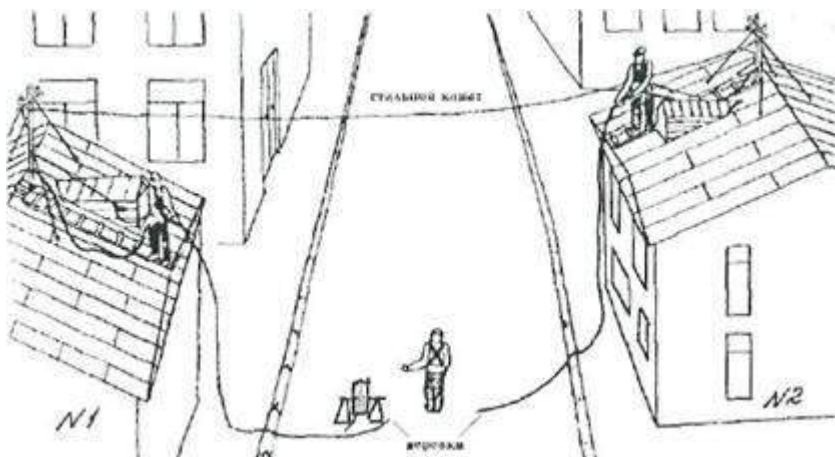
Способ подвески кабеля на стойках с помощью веревок, спущенных с крыш зданий.
